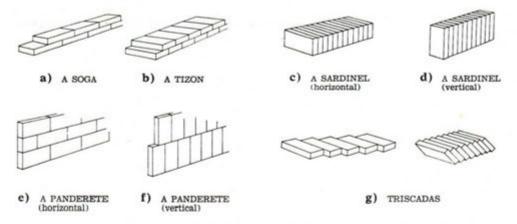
DISPOSICION DE LAS PIEZAS EN LA OBRA DE FABRICA
